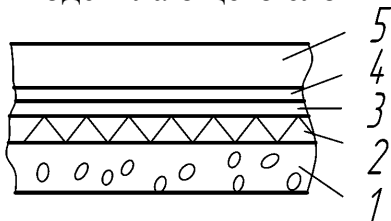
Элементы пола по перекрытию: 1 - плита перекрытия; 2 - тепло- и звукоизоляционный слой; 3 - выравнивающий слой; 4 - гидроизоляция; 5 – покрытие
